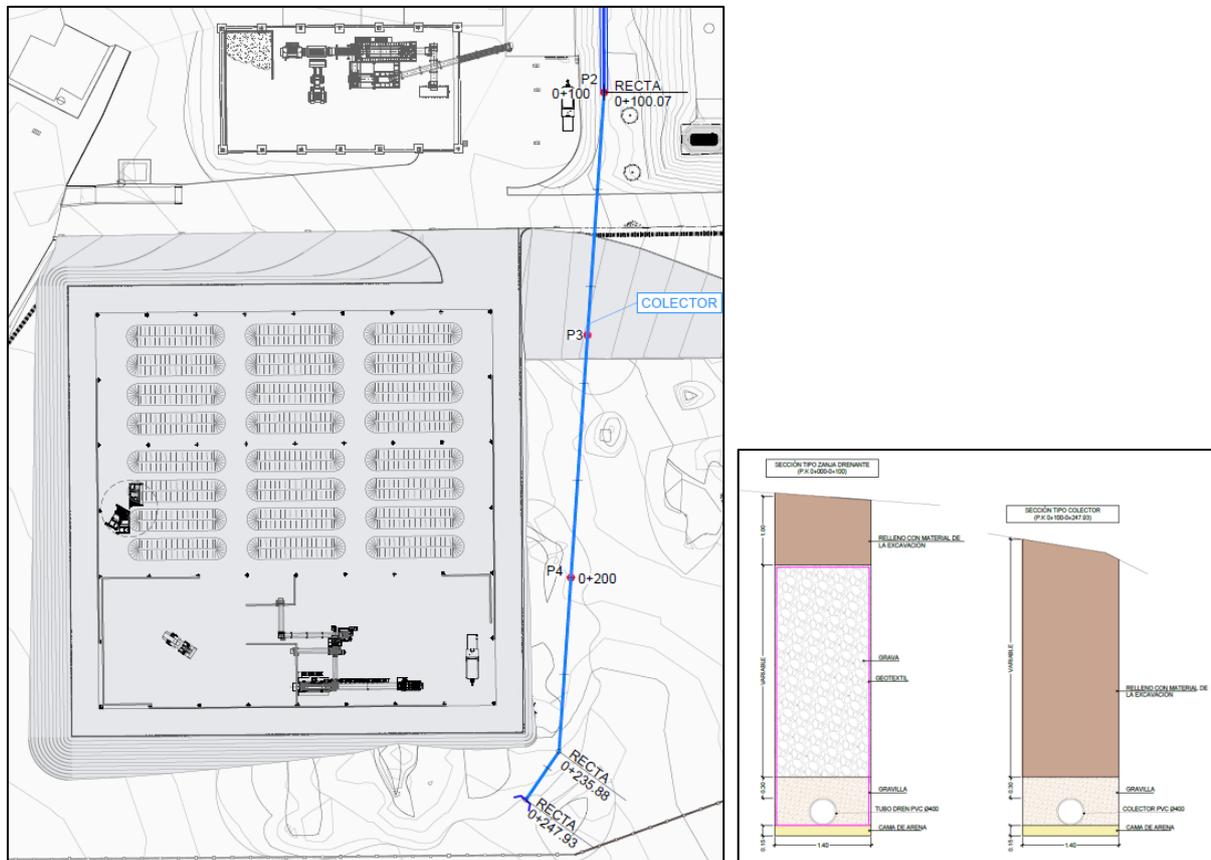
Planta del colector y secciones tipo de zanja y colector.
